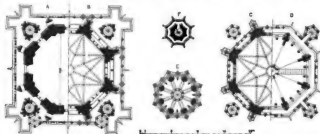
Grundrisse von Achteck und Helm.
